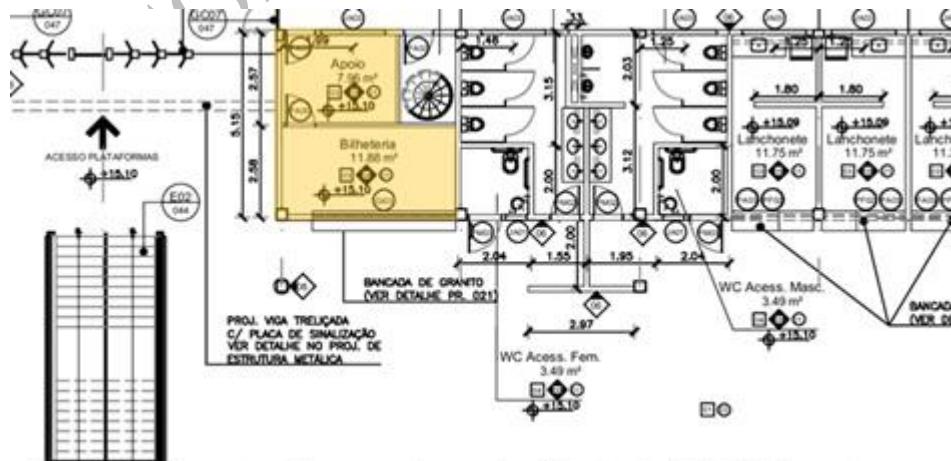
Área do Posto de Venda (Bilheteria e Apoio) das Estações de Passageiros “Tipo 1” da Avenida Almirante Barroso
